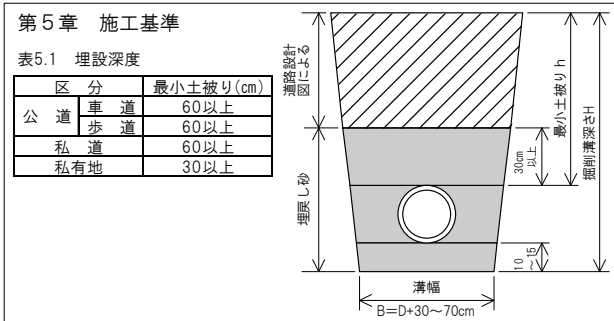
架橋ポリエチレン管の施工基準（埋設工法）
